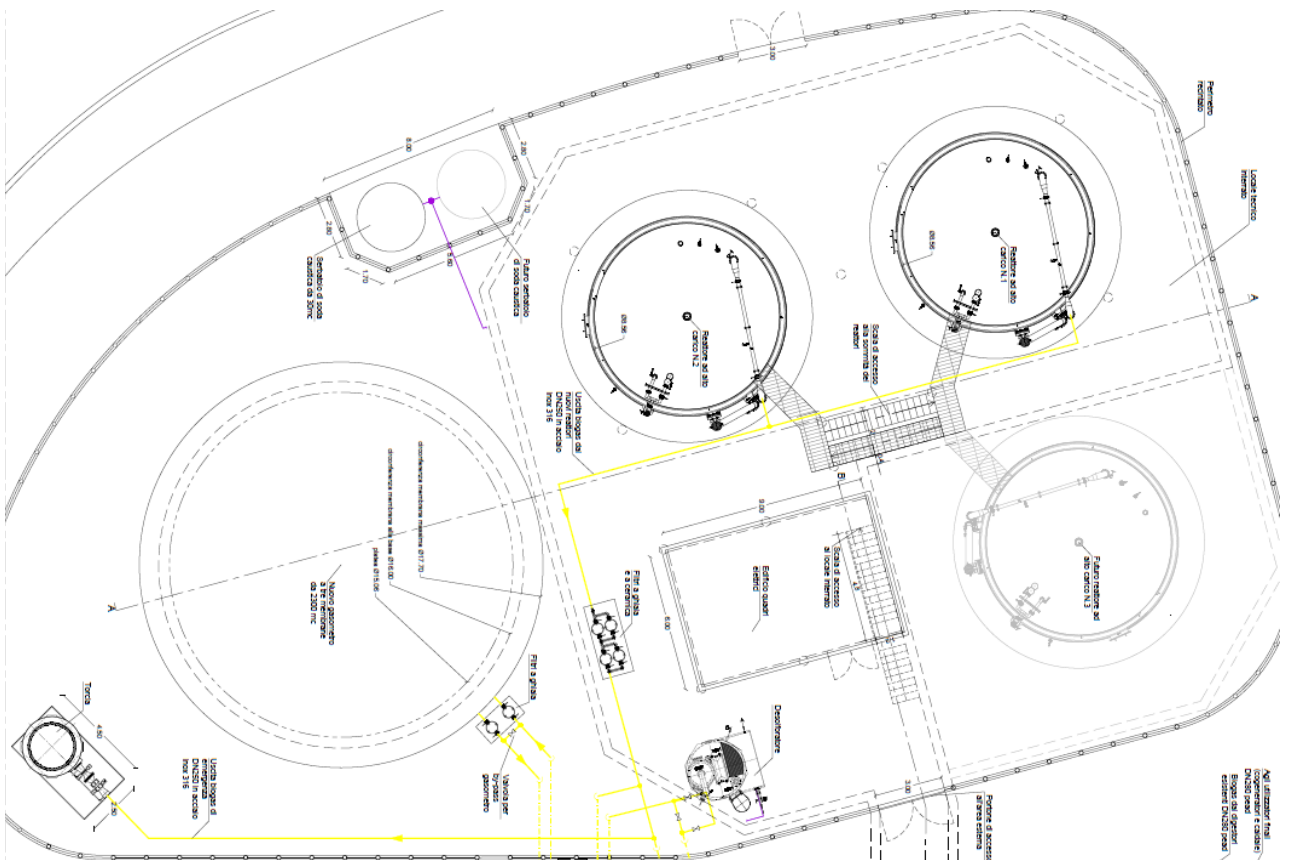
Grundriss Bereich Gasometer und Reaktoren / planimetria zona gasometro e reattori
